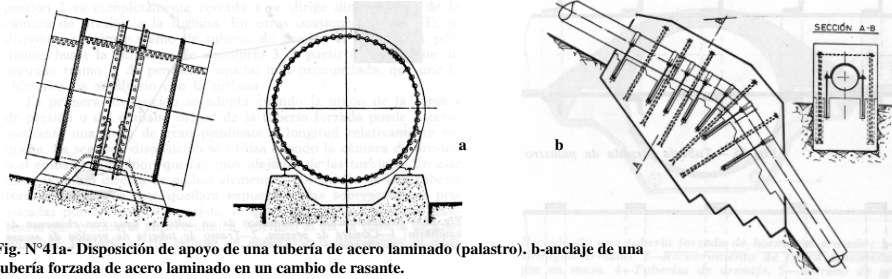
Disposición de apoyo de una tubería de acero laminado (palastro). b-anclaje de una tubería forzada de acero laminado en un cambio de rasante.
